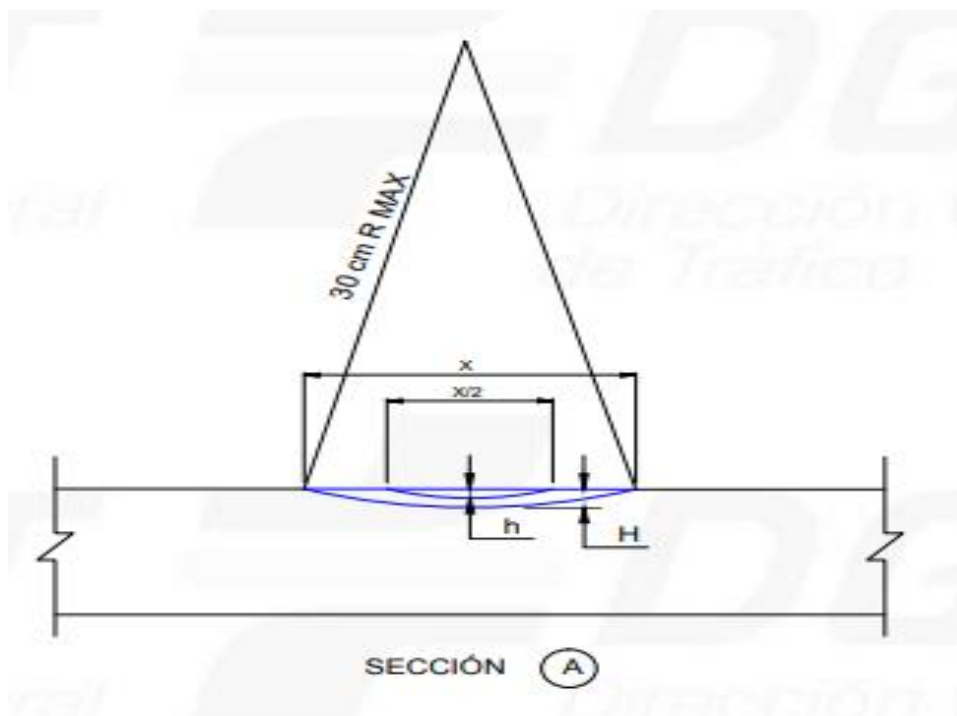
DGT (2018). Sección longitudinal de guía sonora longitudinal trapezoidal.
